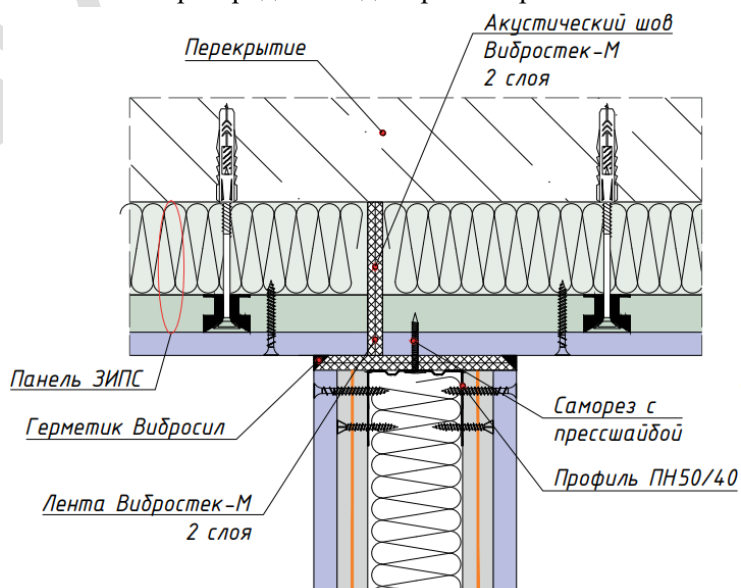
Примыкание звукоизоляционной каркасной облицовки к звукоизоляционной перегородке на одинарном каркасе.
